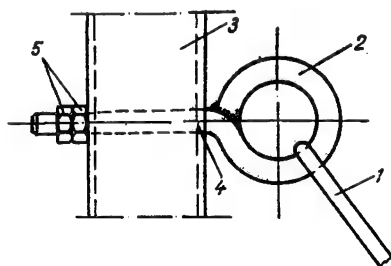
Contravîntuire cu tirant din oțel-beton :
